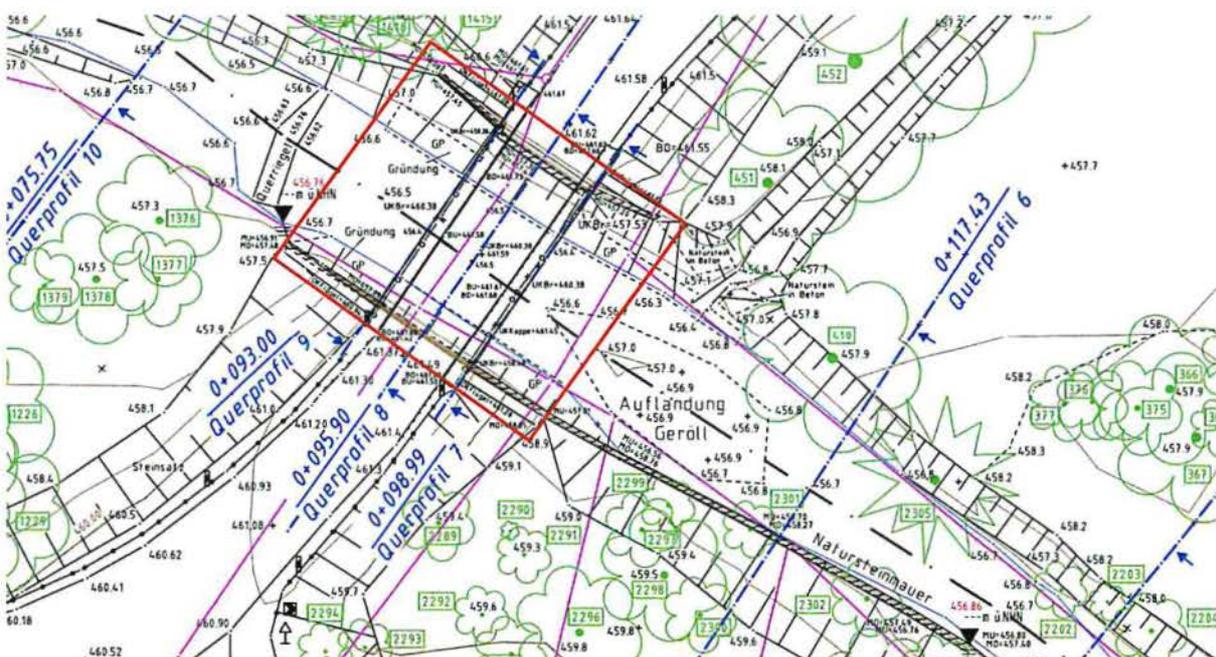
Brücke im Lageplan Bestandsvermessung (VB Gradke-Hanzsch, 22.05.2019)
